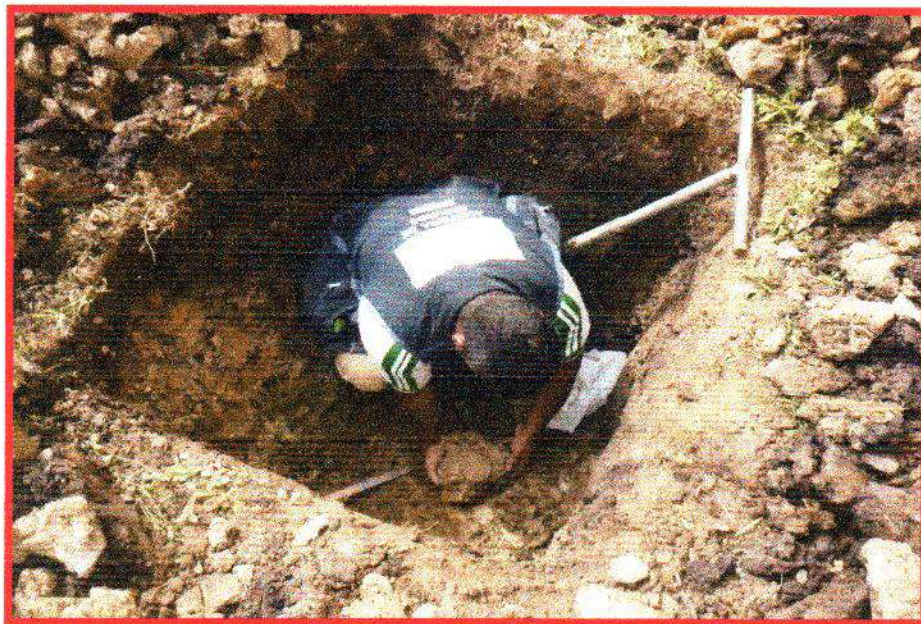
Detalle del perfil del suelo en calicata C-1.
